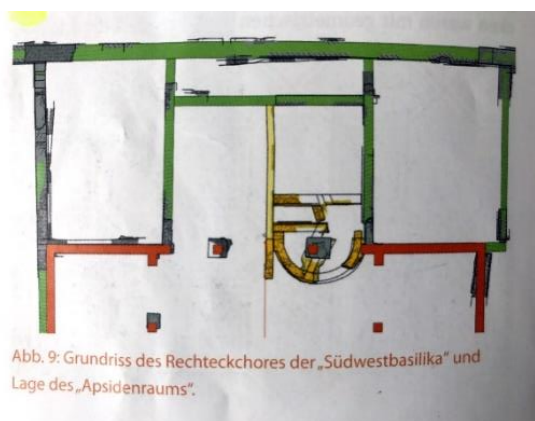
Grundriss des Rechteckchores der „Südwestbasilika“ und Lage des „Apsidenraums“.
